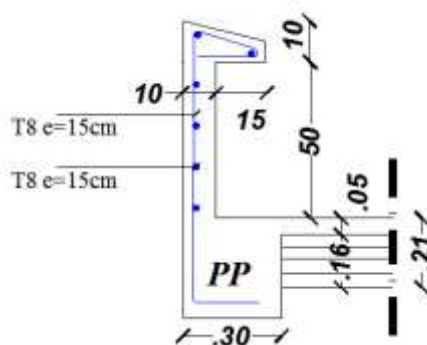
Ferrailage de l'acrotère type1 (Terrasse inaccessible)
